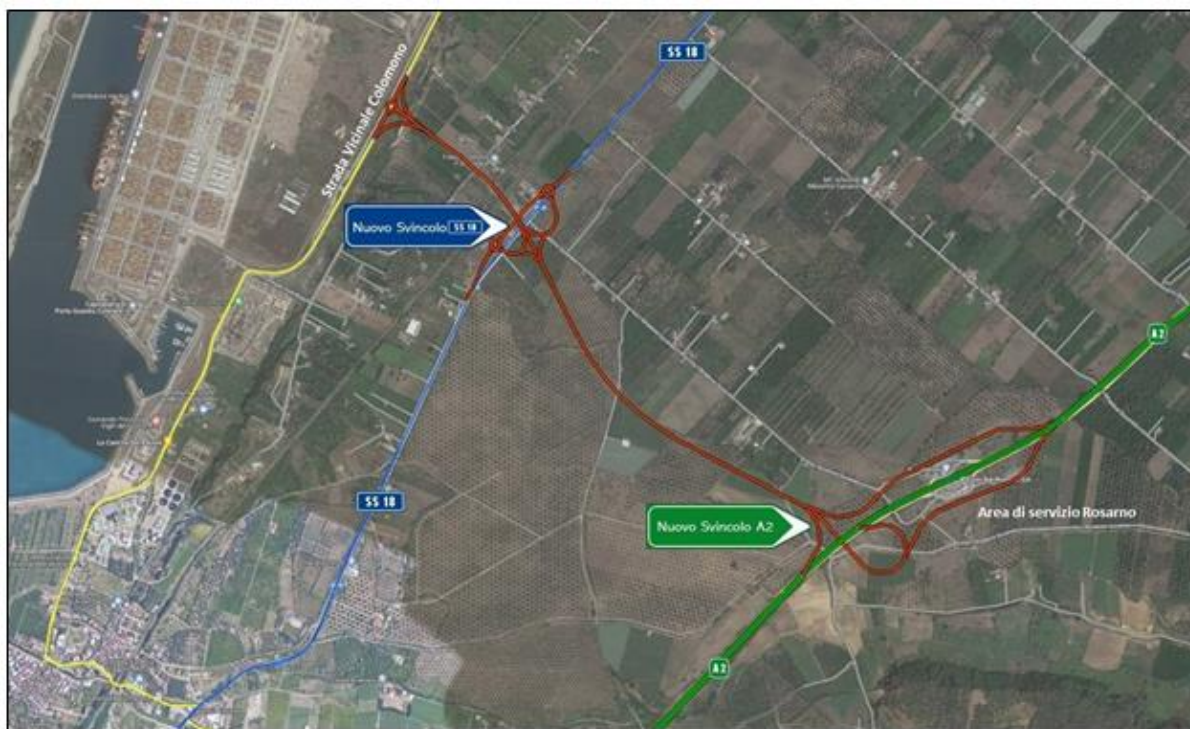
Tracciato di progetto del nuovo collegamento stradale
